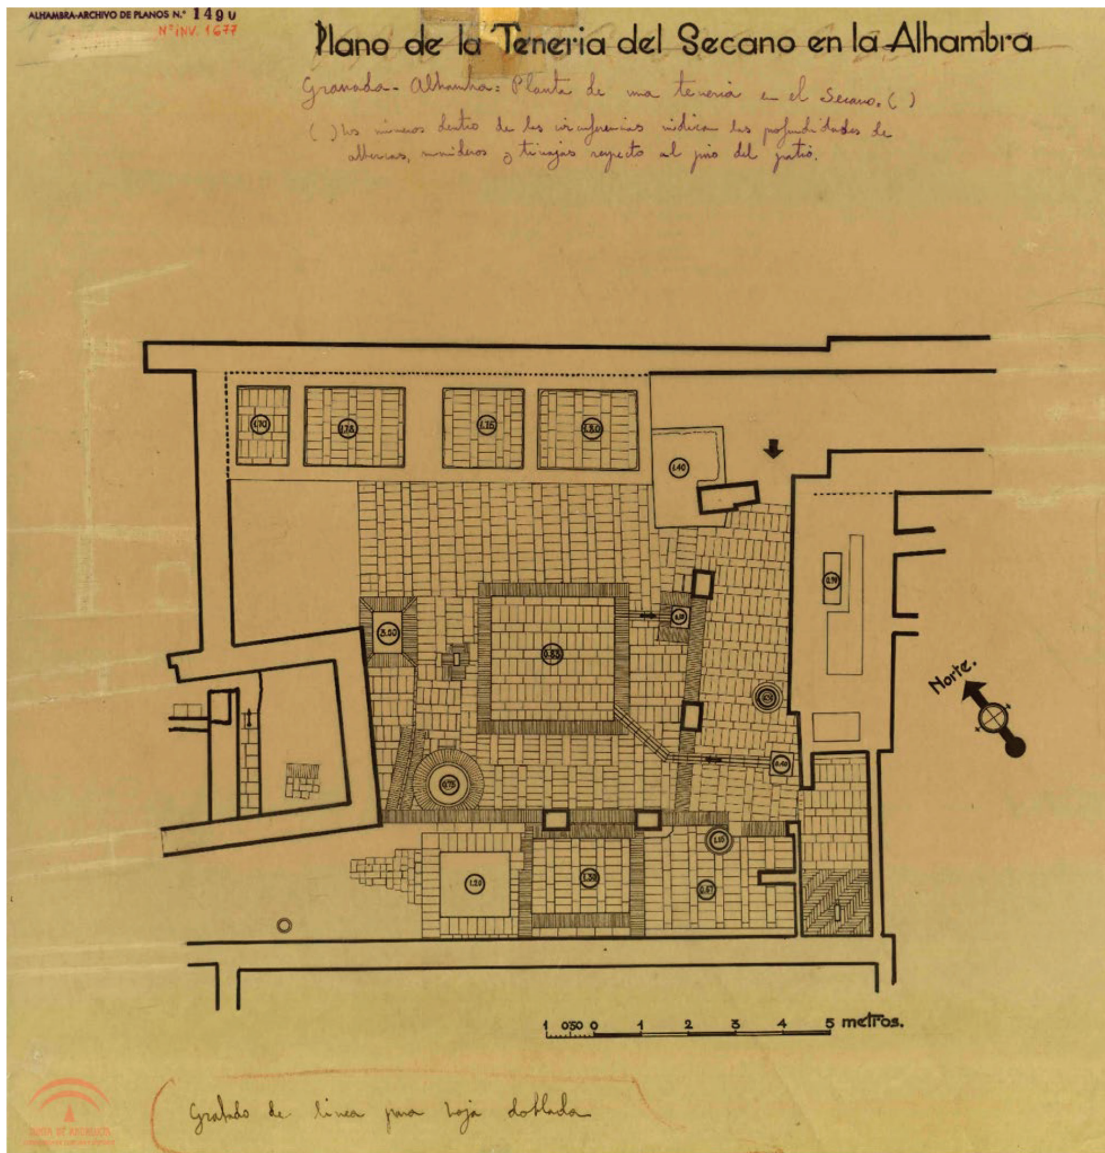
Plano de la tenería del secano de la Alhambra (TORRES, 1935)
